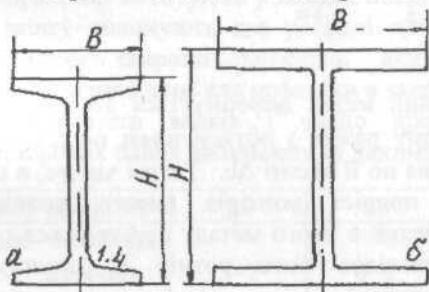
Профілі стандартної (а) та широкополочної балок (б)
